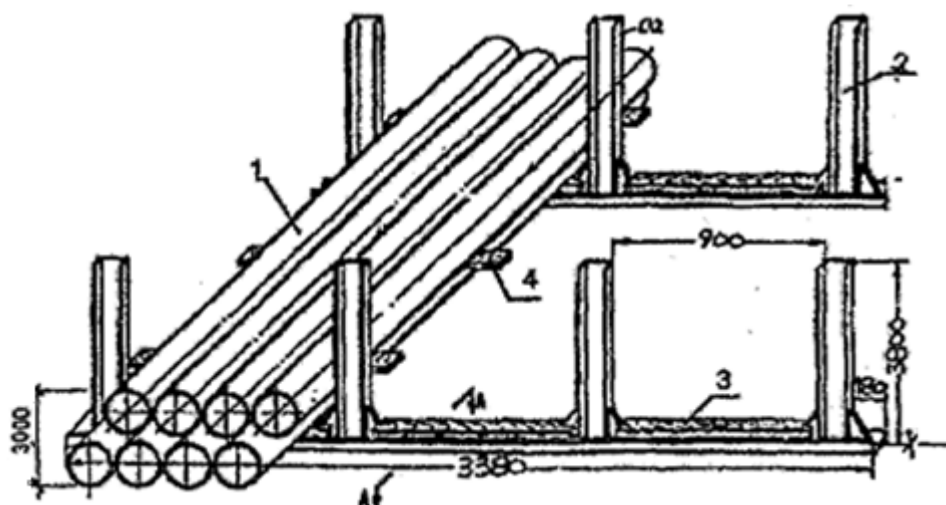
Стеллаж для хранения полиэтиленовых труб
